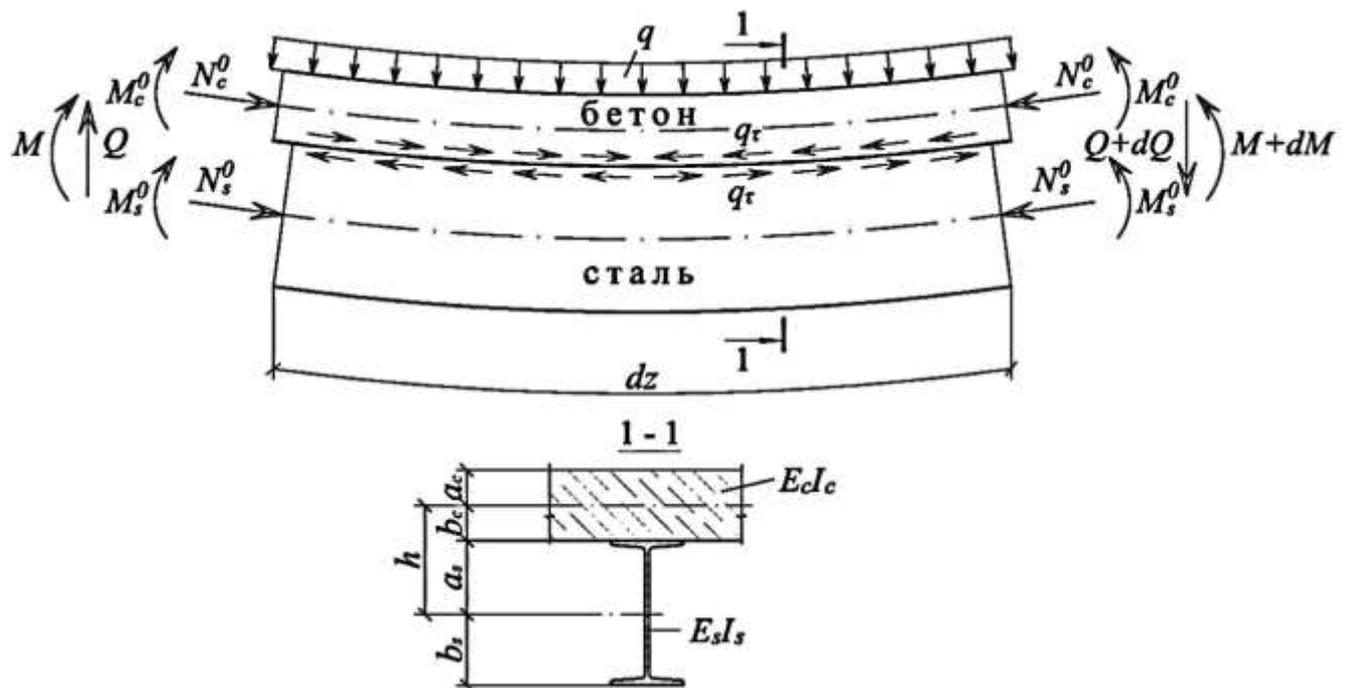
Елементарна ділянка двошарового згинаного сталезалізобетонного елемента із заміною зв'язків зсуву на дотичні зусилля, а відкинутих частин балки – на внутрішні зусилля
